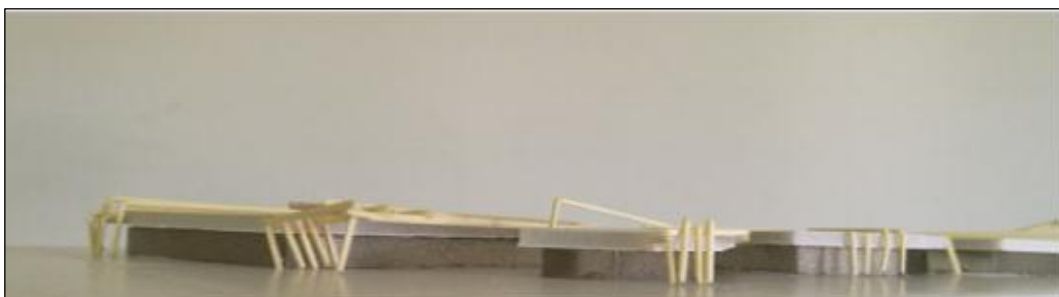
Vista 2 en Elevación de Maqueta de Partido Arquitectónico
